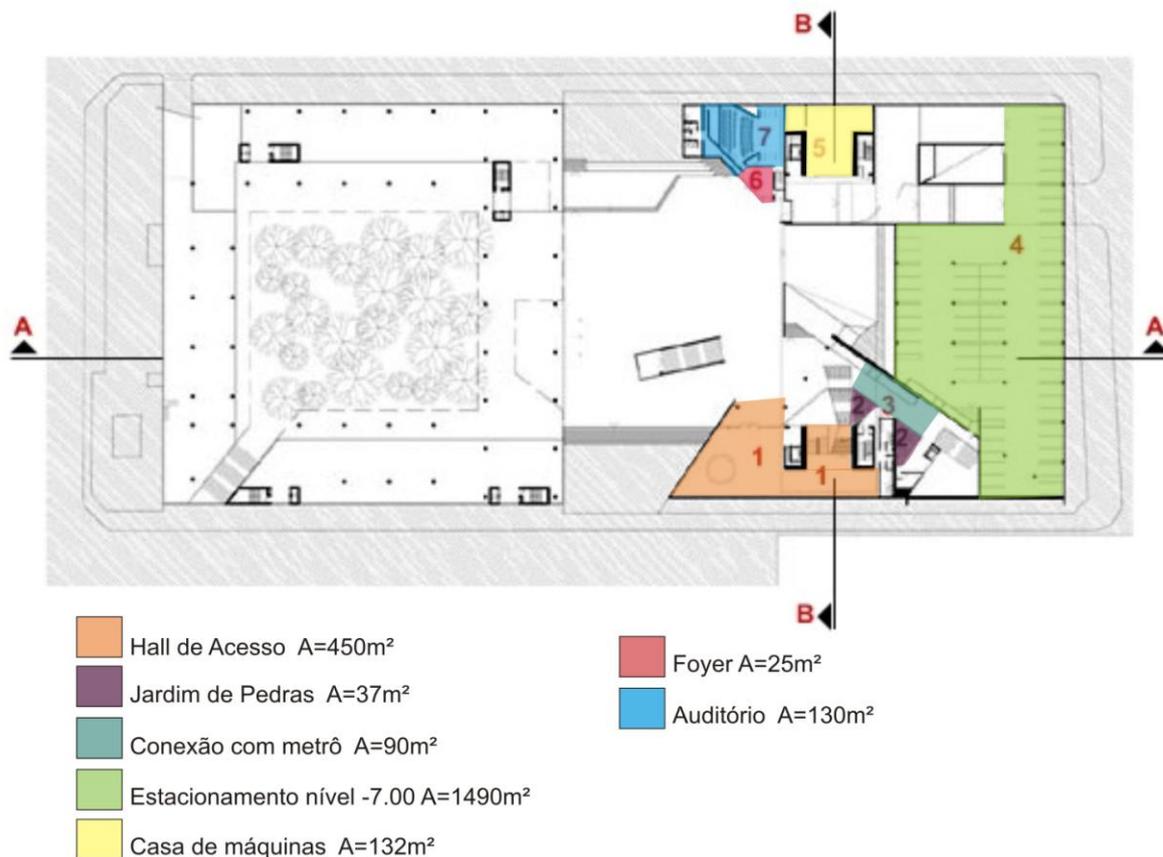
Planta Baixa Nível -5,95/-7,00 (ARCOWEB, 2010)
